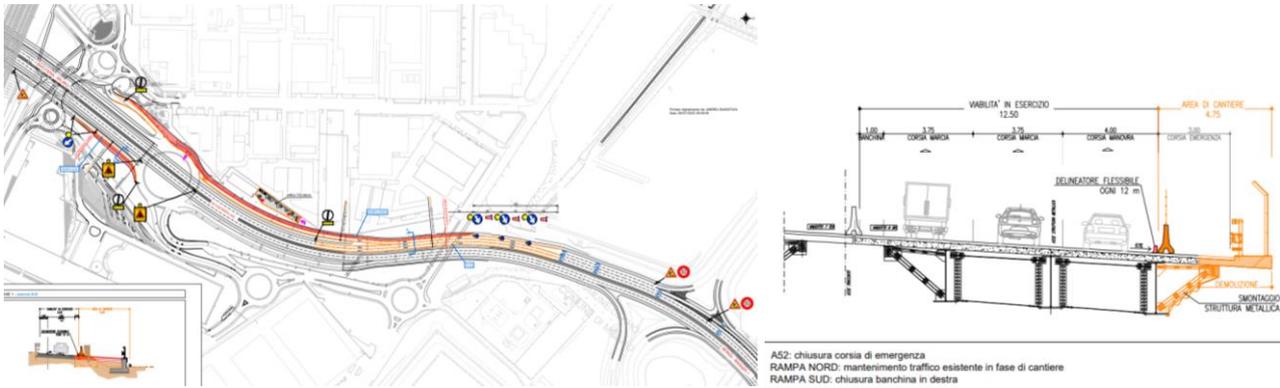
Planimetria delle cantierizzazioni 1/3 (Fonte Allegati alla Lista di controllo)
